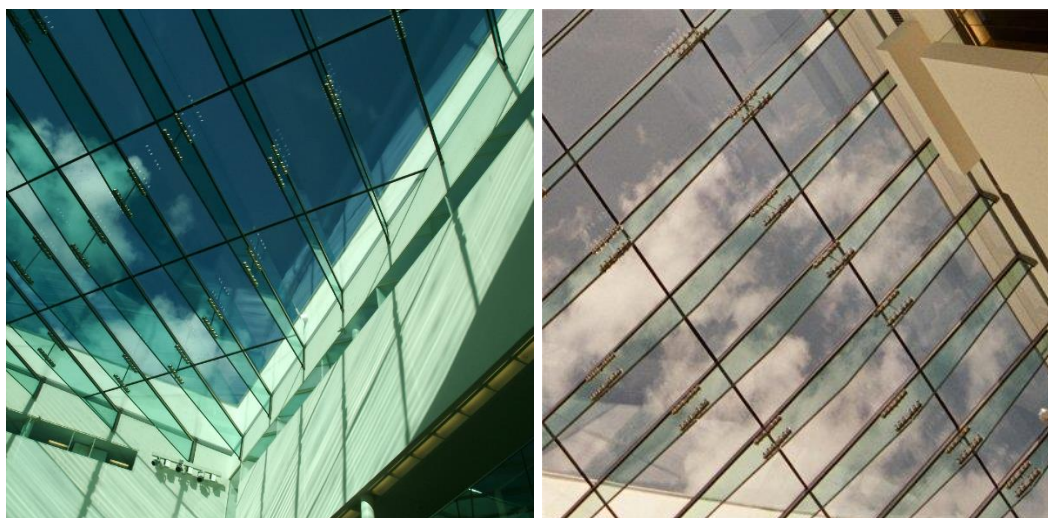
Rozdělení přípojů skleněných konstrukcí [6]
